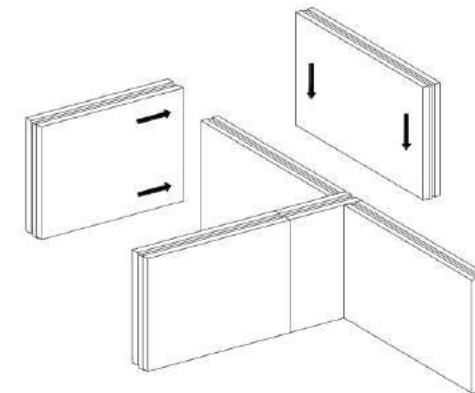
Порядок укладки МАГМА-гипсоплит в углах и местах пересечения перегородок
